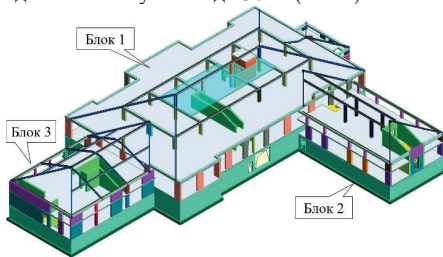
Загальний вигляд несучих конструкцій малоповерхового будинку
